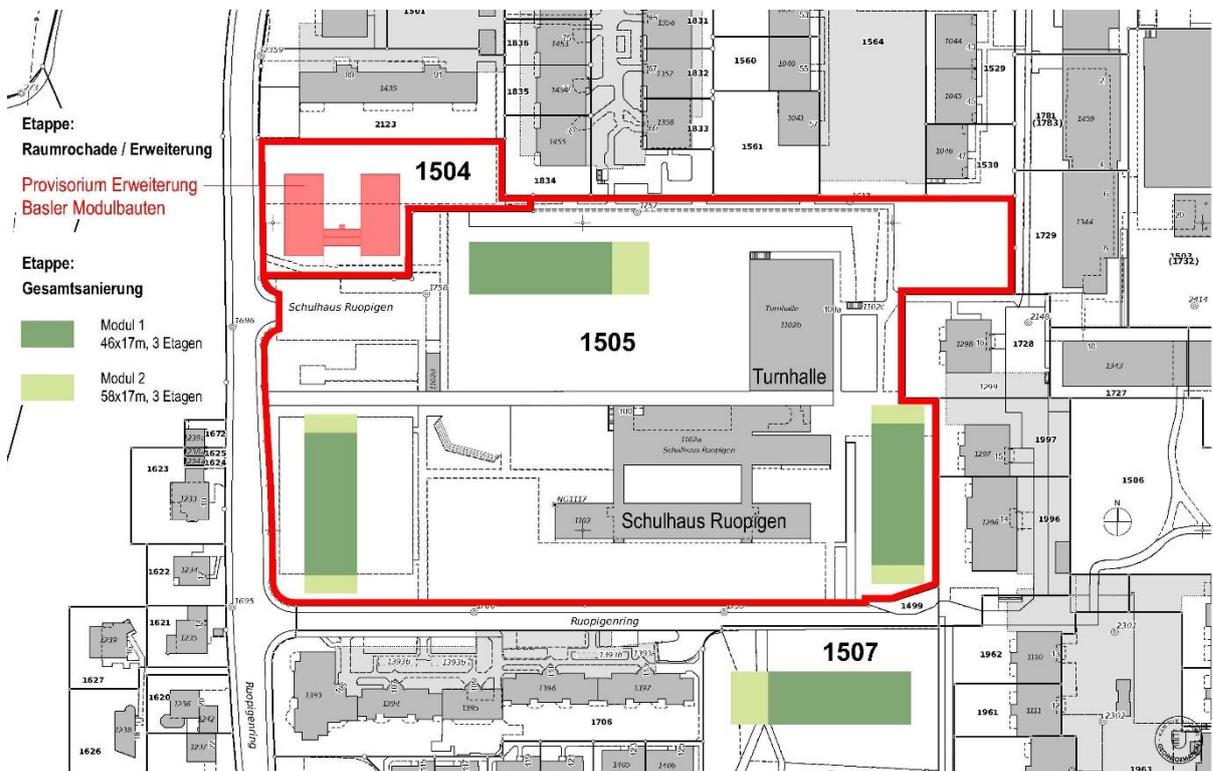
Situationsplan neu mit möglichen Standorten der Provisorien der Gesamtanierung
